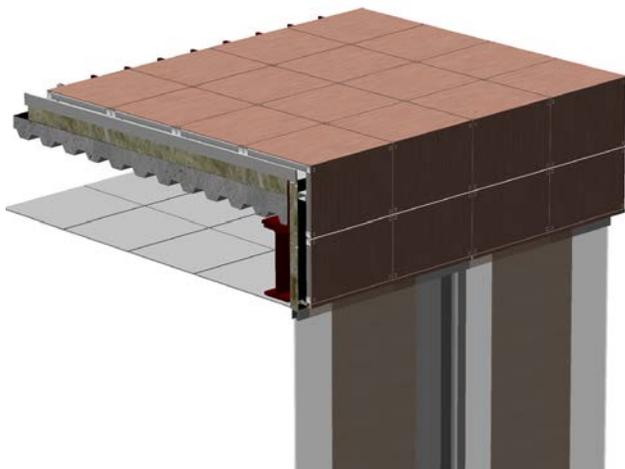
Detaillierte 3D-Darstellung der Fassadenkonstruktion
